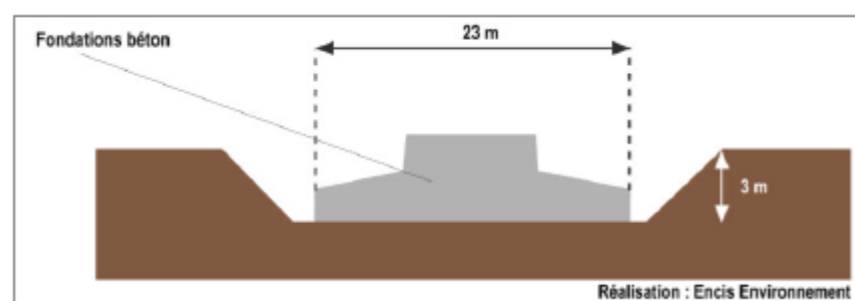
schéma d'une fondation en béton (source Encis Environnement)
